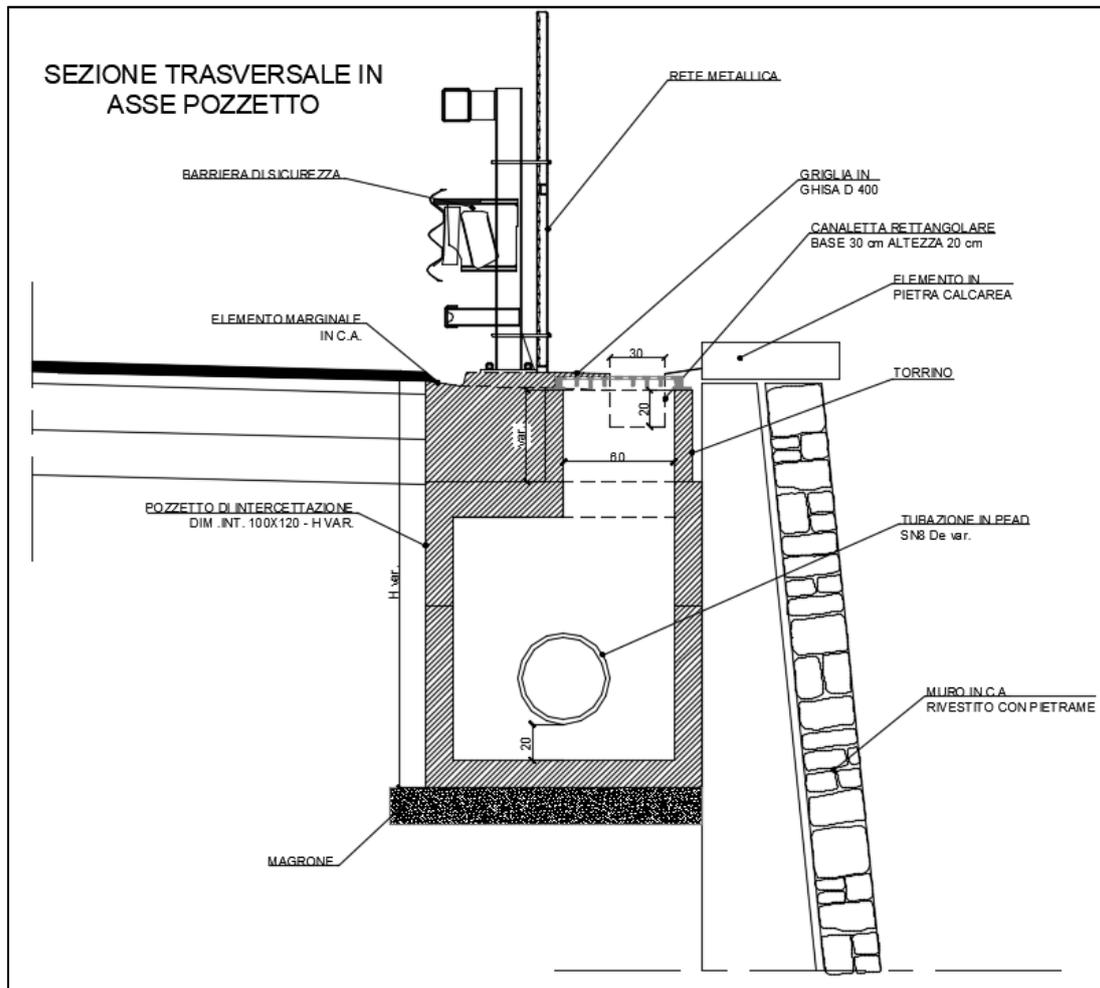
Sistema di smaltimento in rilevato con muro di sottoscarpa – sezione del pozzetto di scarico
